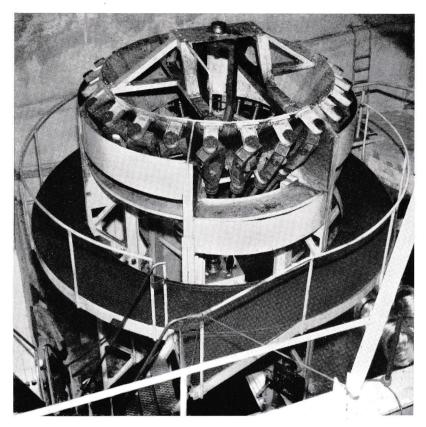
La máquina representada en la fig. 1, vista desde arriba
